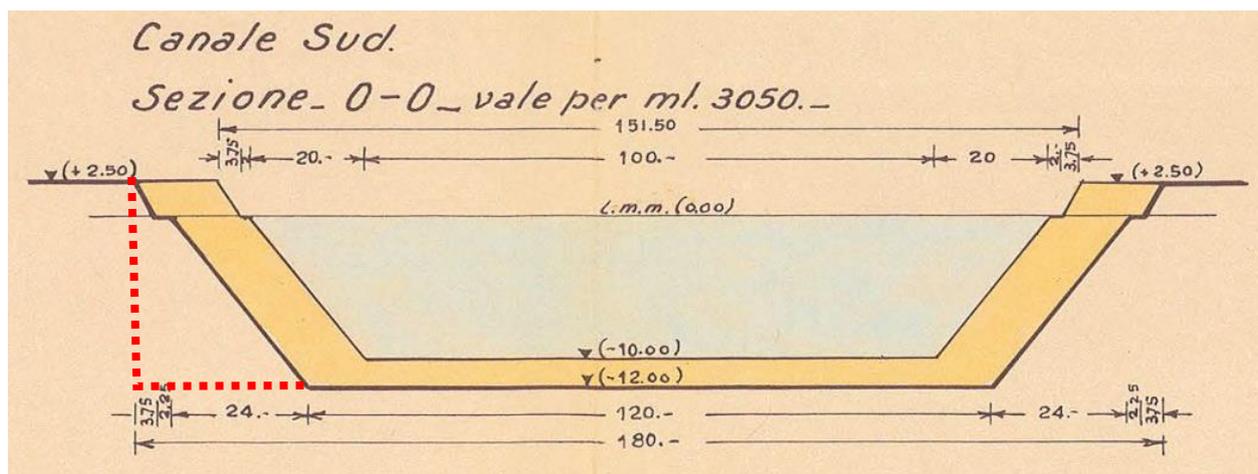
Estratto PRP 1965 – Sezione 0 – 0 con risagomatura cunetta di navigazione lato sud
